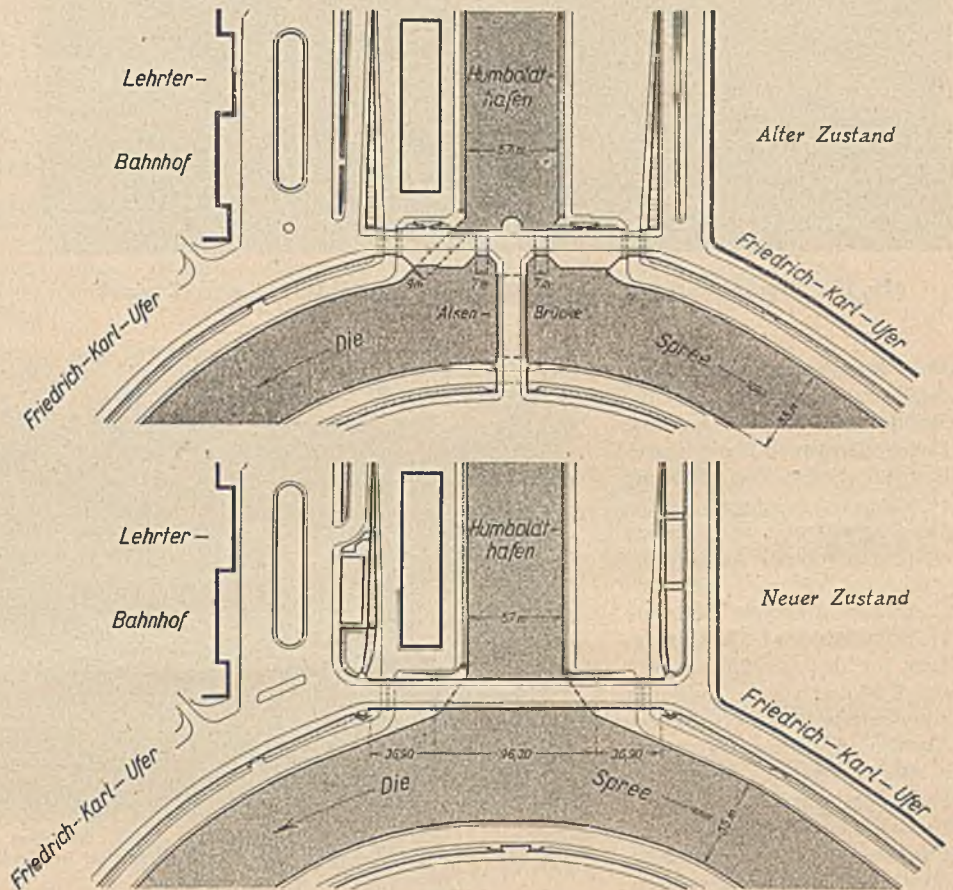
Brücke über den Humboldthafen in Berlin-Mitte. — Lageplan. Vor und nach dem Umbau.
